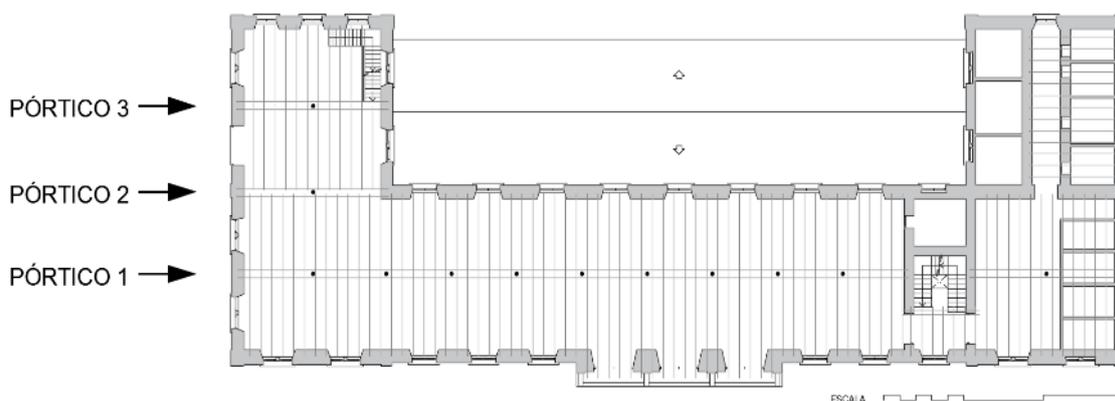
Esquema estructural. Pilares de planta segunda y forjado de planta tercera.
